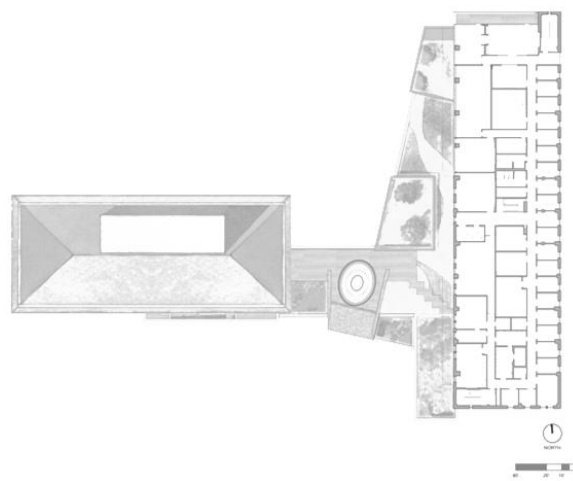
Planta Tercer Nivel (Student Activity Center) | Fuente: ArchDaily
